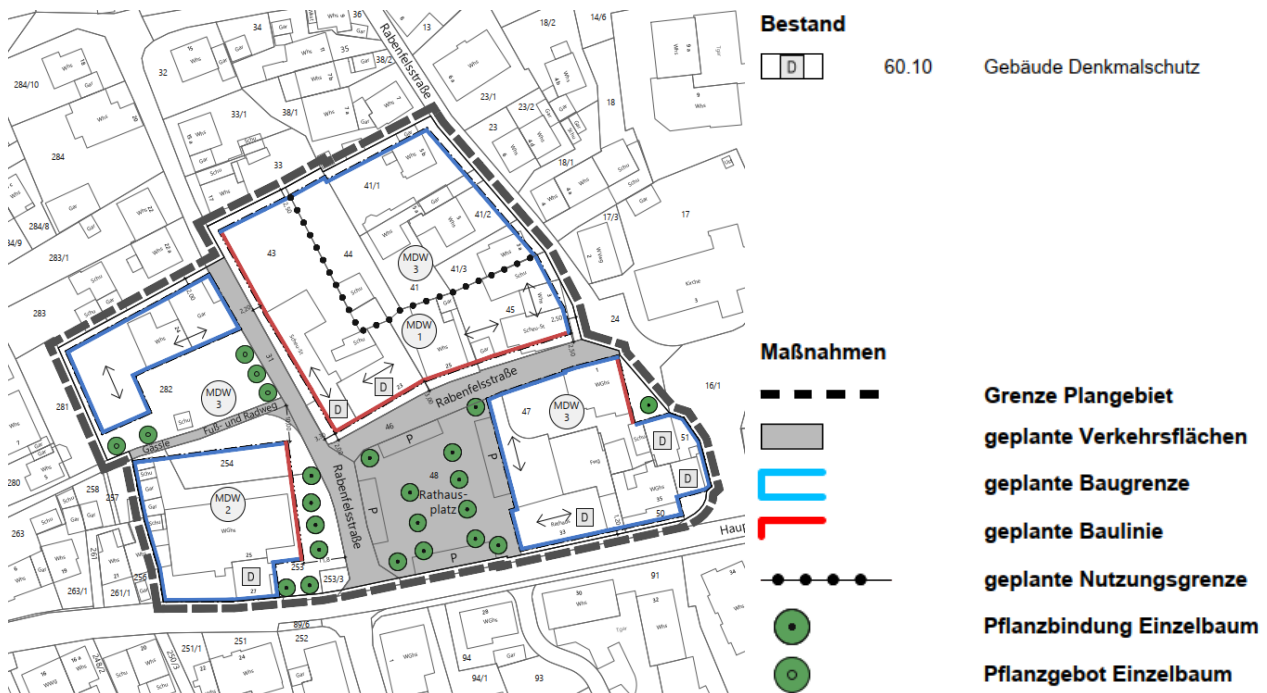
Maßnahmenplan (Quelle: galaplan decker, Stand: 26.03.2026)
